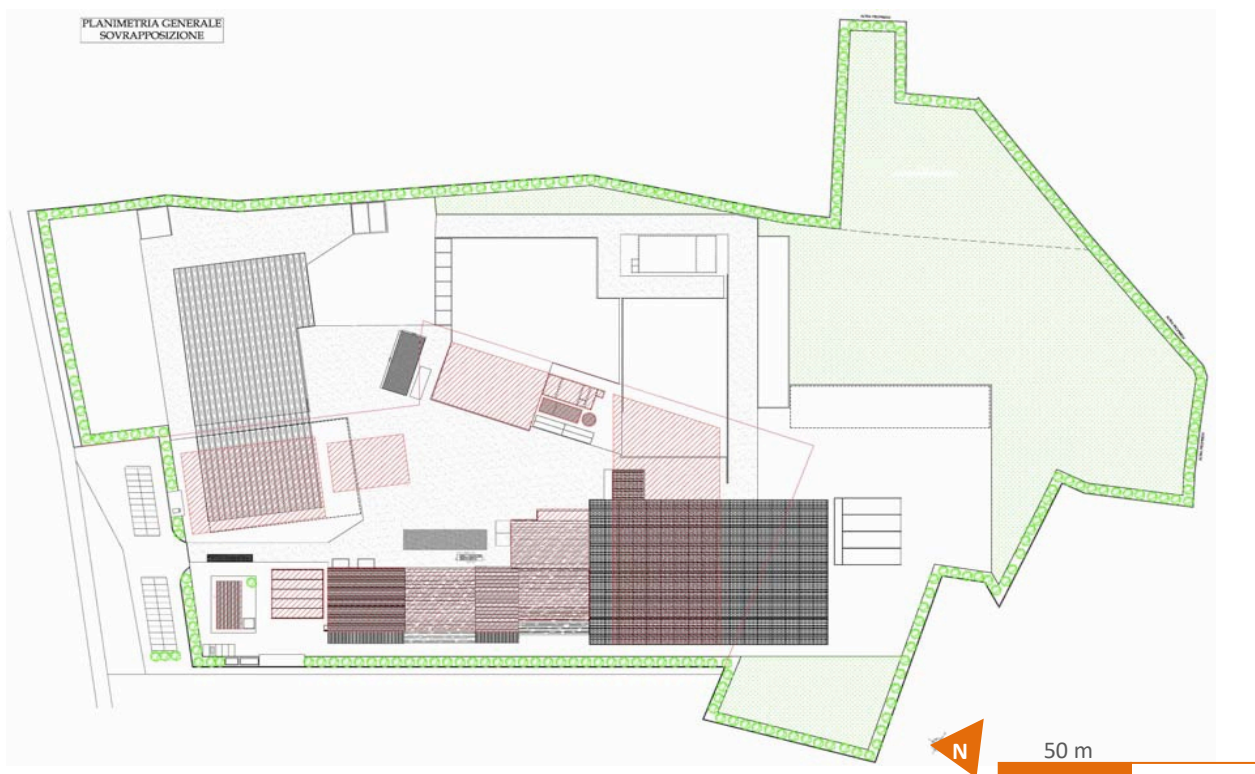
Planimetria generale –sovrapposizione ante e post operam
